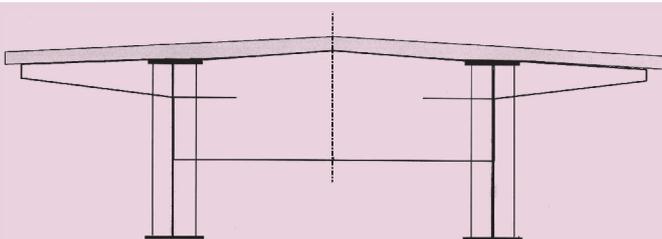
Pièces de pont sur piles des ouvrages importants
